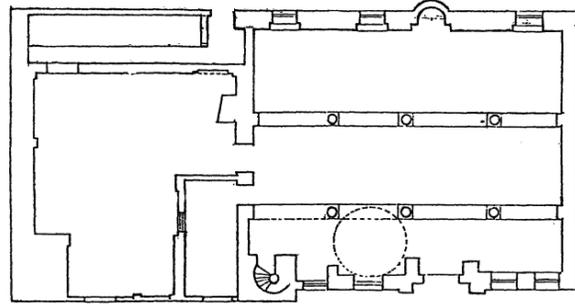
المسقط الأفقي لمسجد سيدي خميس بالمنوفية.
